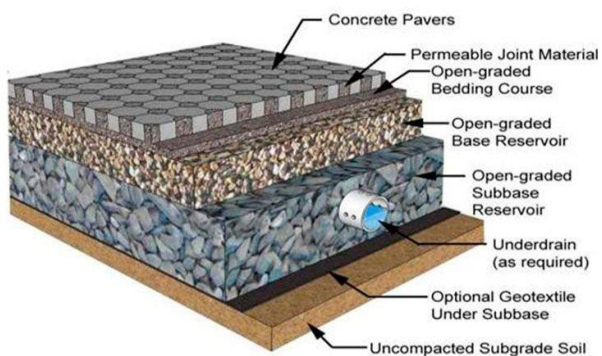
Estructura típica de un pavimento permeable. (Motos, n.d.).
